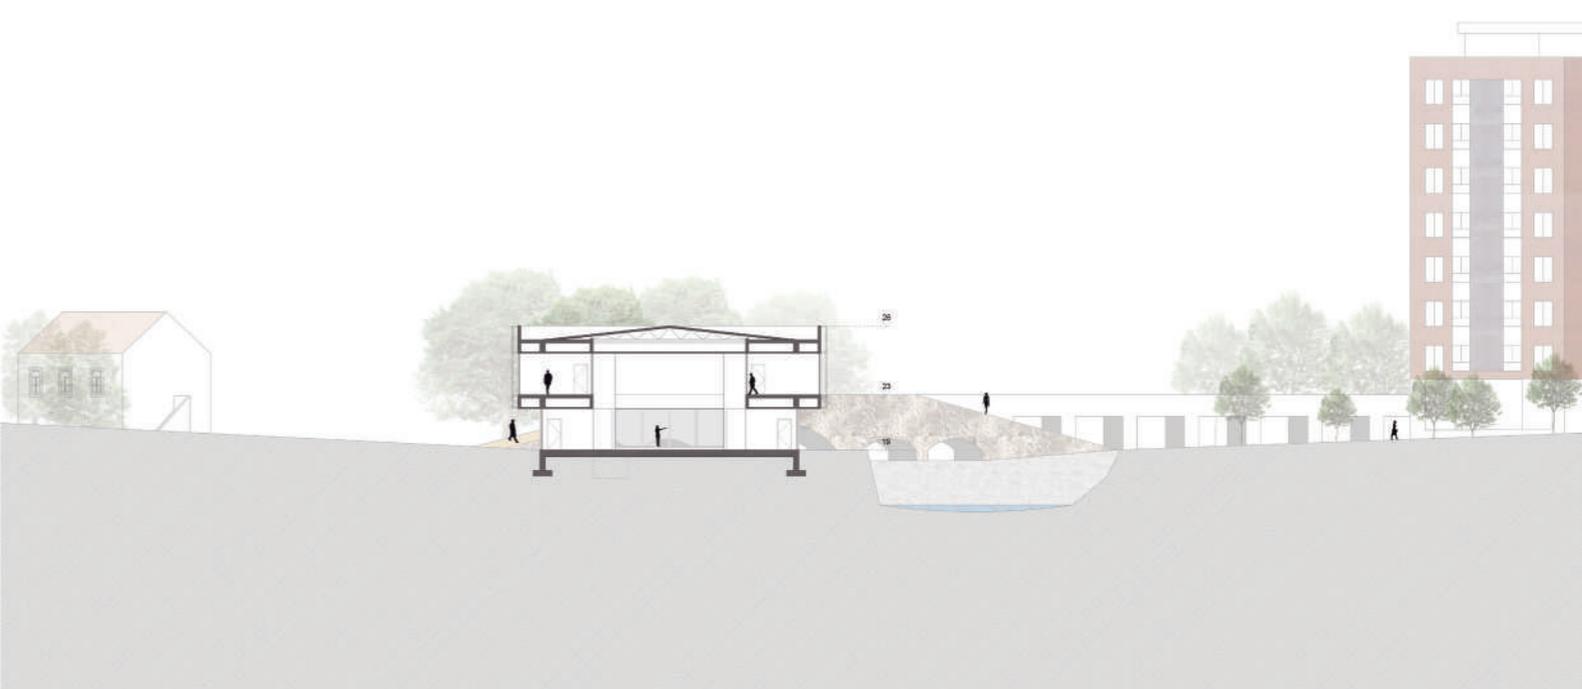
Corte Transversal C-C' (redução da escala 1:200)
